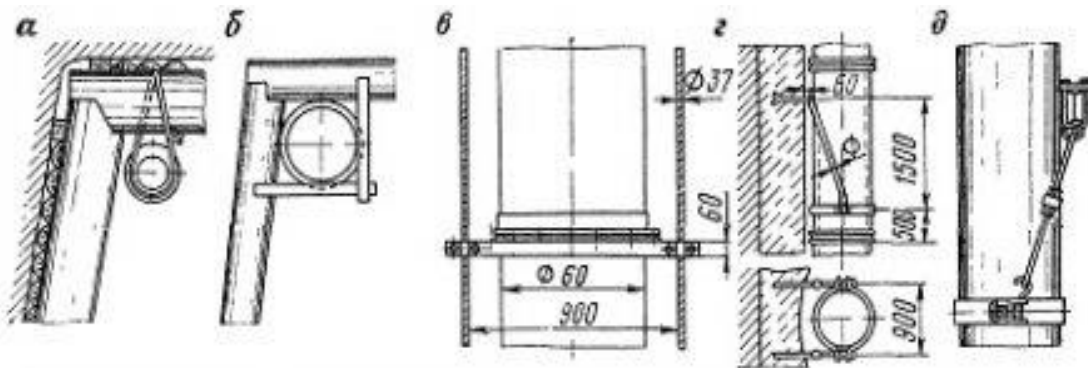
Способы подвески металлических вентиляционных трубопроводов: а и б — в горизонтальных выработках; в, г и д — в вертикальных выработках
